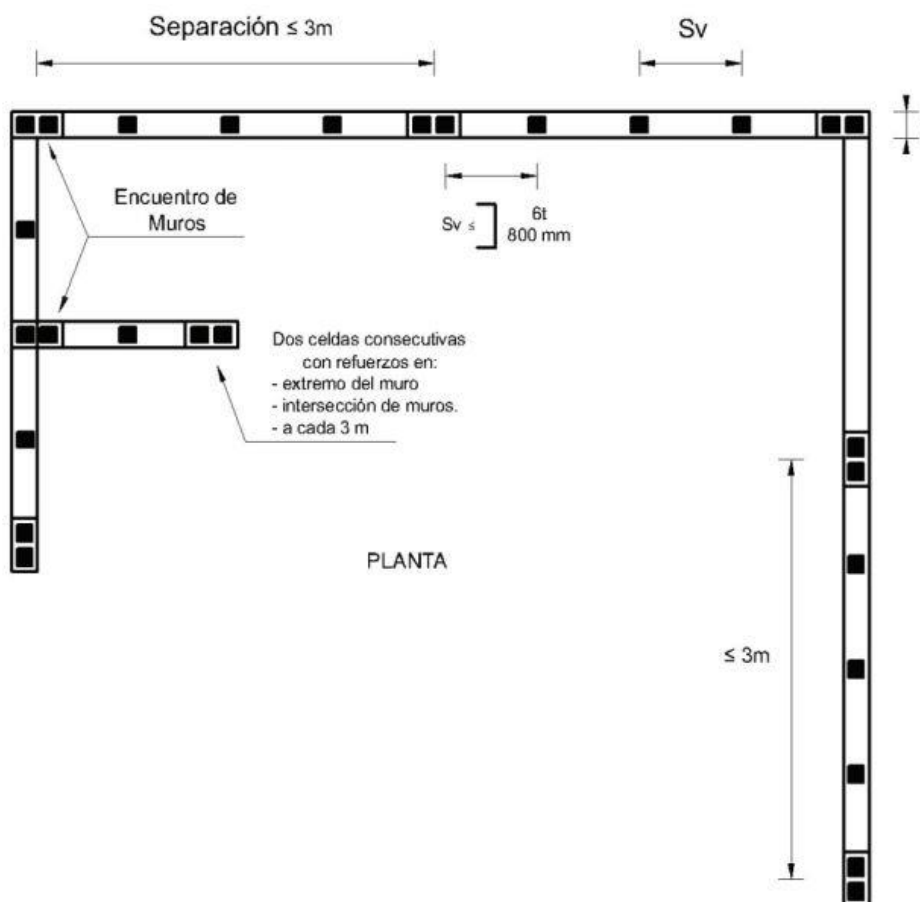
Planta típica de muros reforzados, ubicación del refuerzo vertical
